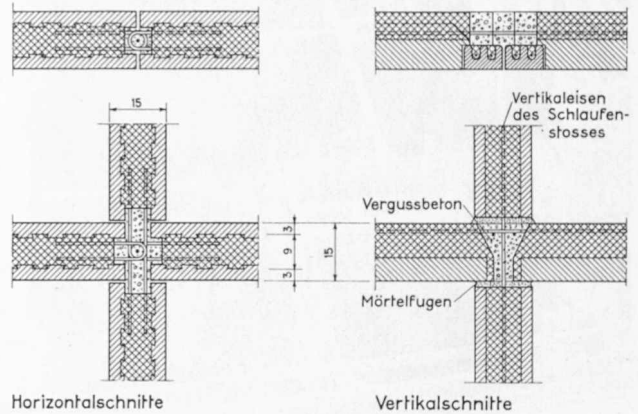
Verbindungen. *Linke Bildseite:* Grundriss der Ausbildung des Schlaufenstosses für 2 Wände (oben) und 4 Wände (unten). *Rechte Bildseite:* Vertikalschnitte der Vergussfügen zwischen den Deckenelementen mit der an Ort ausgegossenen Verschweissung der Armierungsstäbe (oben) und Schnitt des Deckenstosses über den Wandauflegern (unten)
